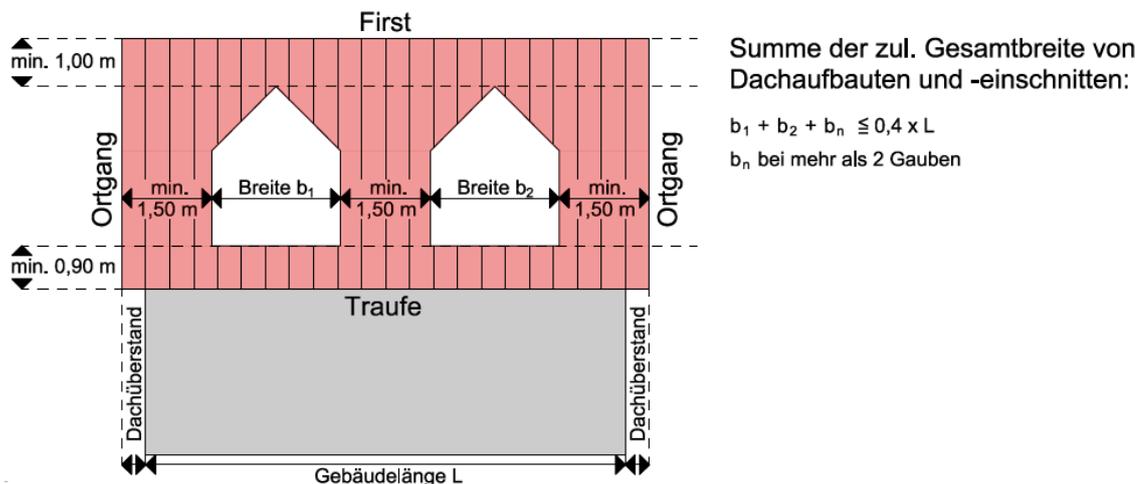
Abmessungen zulässiger Dachgauben (Bsp. Sattelgaube, unmaßstäbliche Darstellung)
